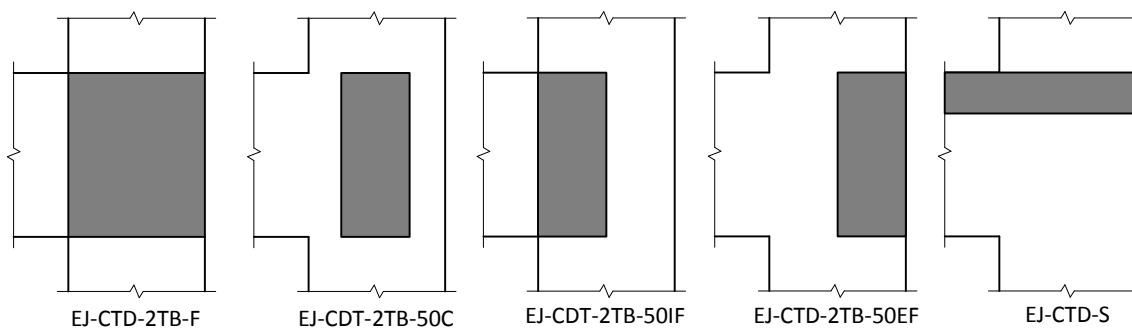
Elementos transversais na ligação viga-pilar de extremidade.
